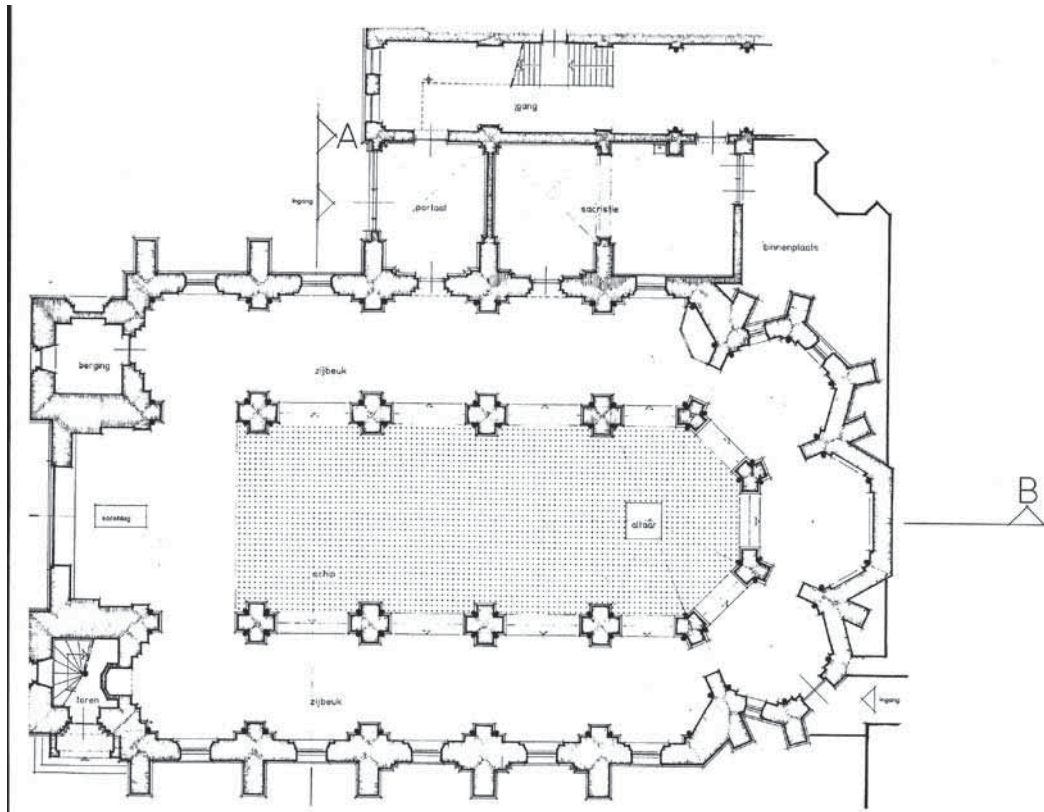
Grundriss Unterkerche, aufgenommen 1995 (Maßstab im Originalplan 1:100)
